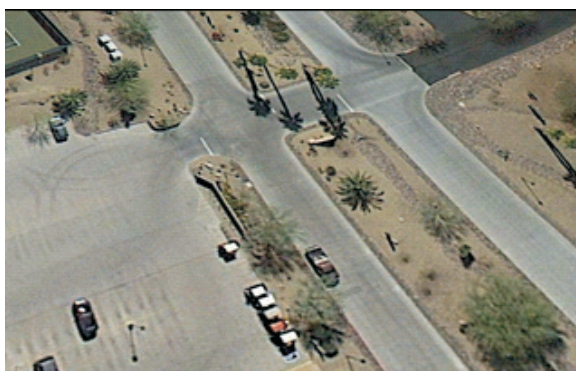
Nawierzchnia betonowa i asfaltowa. Rio Verde, Arizona, Stany Zjednoczone [24]
